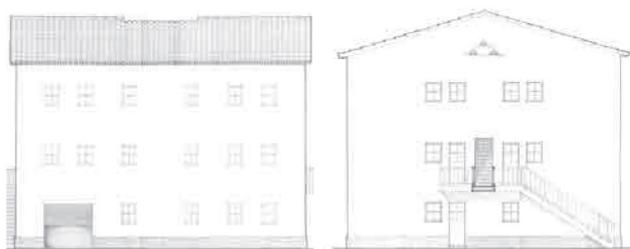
Alzados del bloques de vivienda “albergue”.
